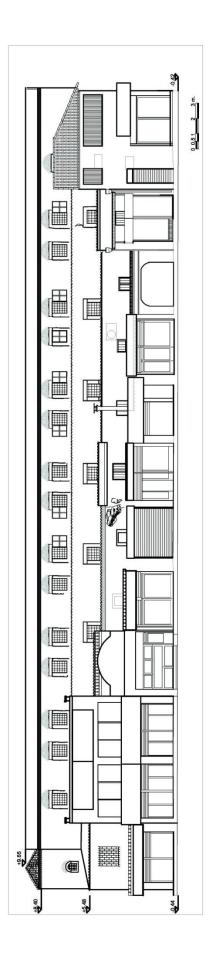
Çakaloğlu Khan, northeastern facade, measured drawing (Source: IZTECH, Department of Architectural Restoration – Digital Archive)
